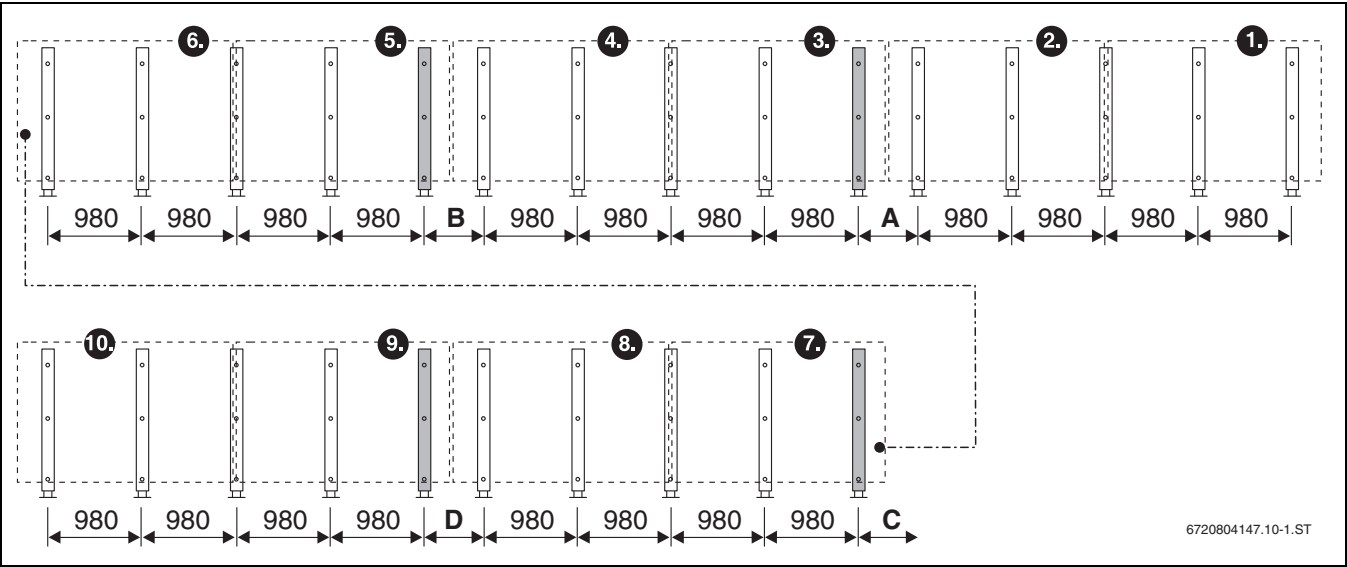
Grundauführung Beschwerungswannen, waagrechte Kollektoren (Angaben in mm)
